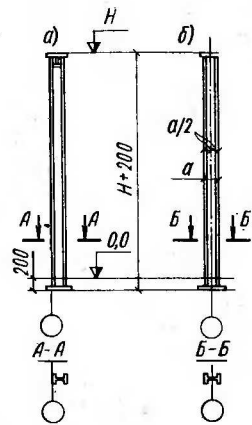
Колонны из одного двутавра для бескрановых зданий
